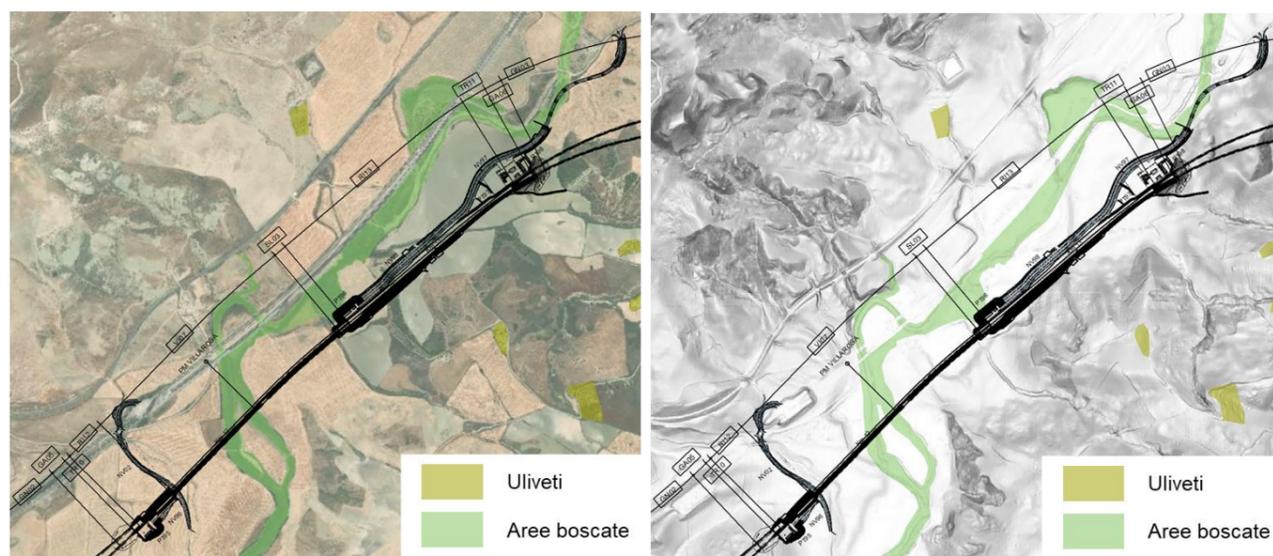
Tratto 3: rapporto con gli elementi strutturanti il paesaggio
